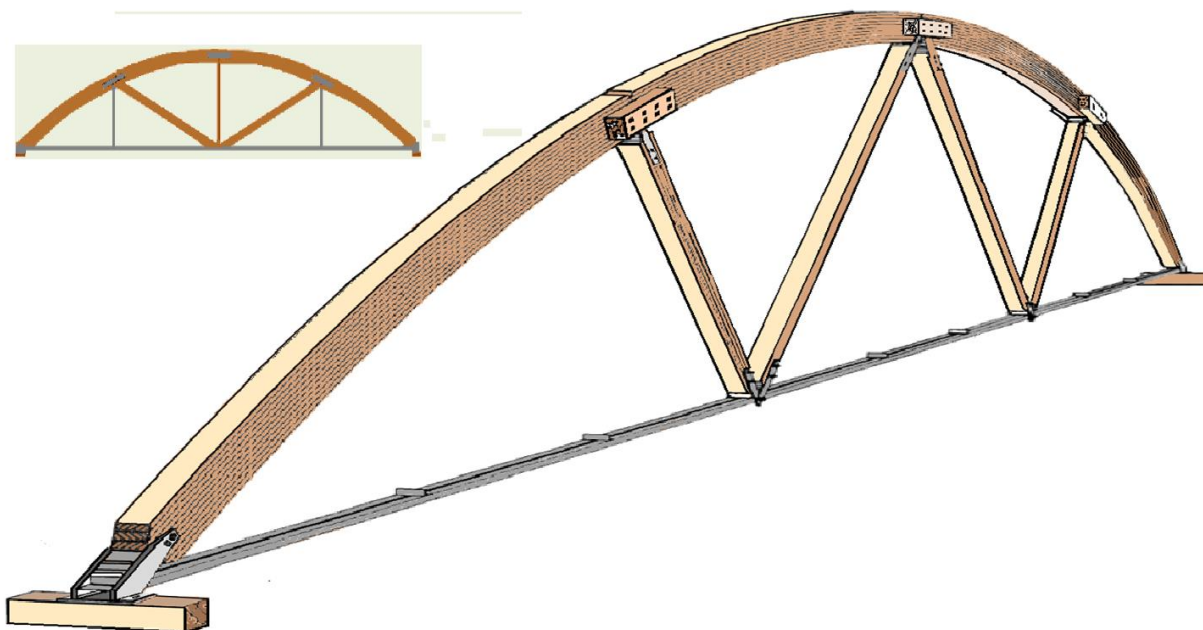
Фермы сегментного очертания с клееным верхним поясом
